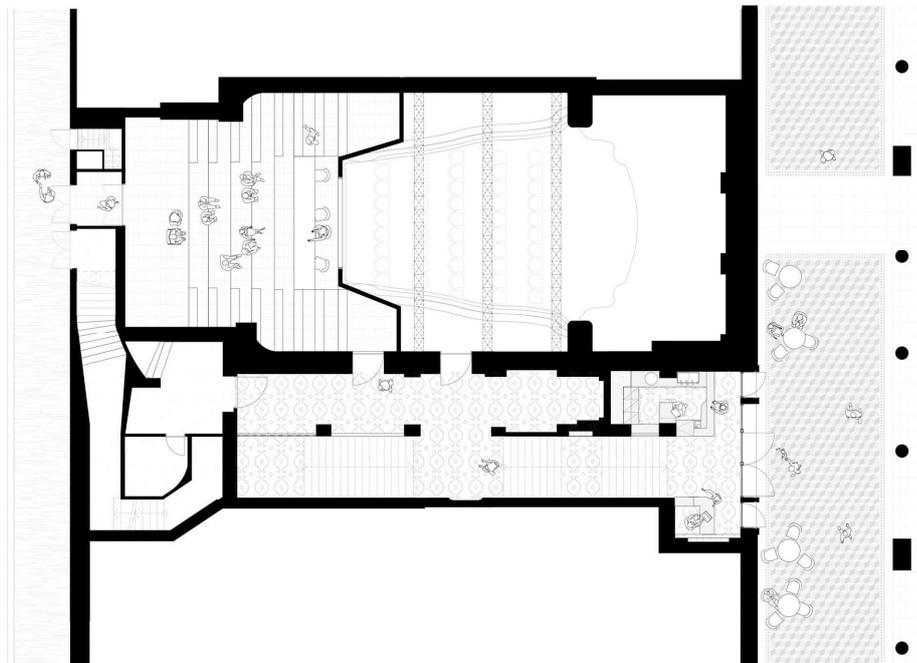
Planimetrie di progetto del caffè Muller dello studio Plac, pianta piano primo 2017
